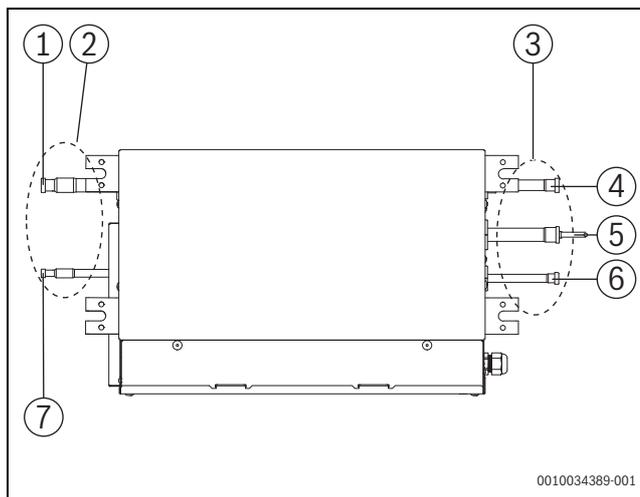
Сварка медных труб—одиночный Sbox
